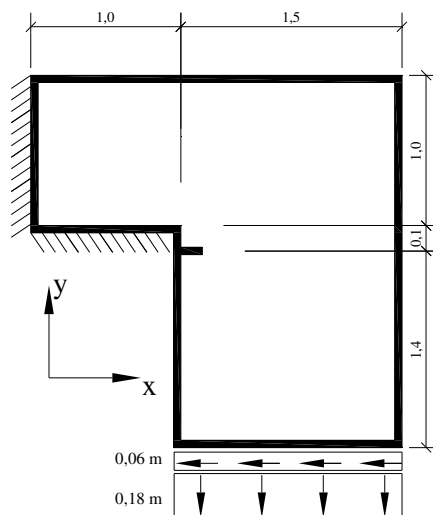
Estrutura e carregamentos considerados. Dimensões em m.
